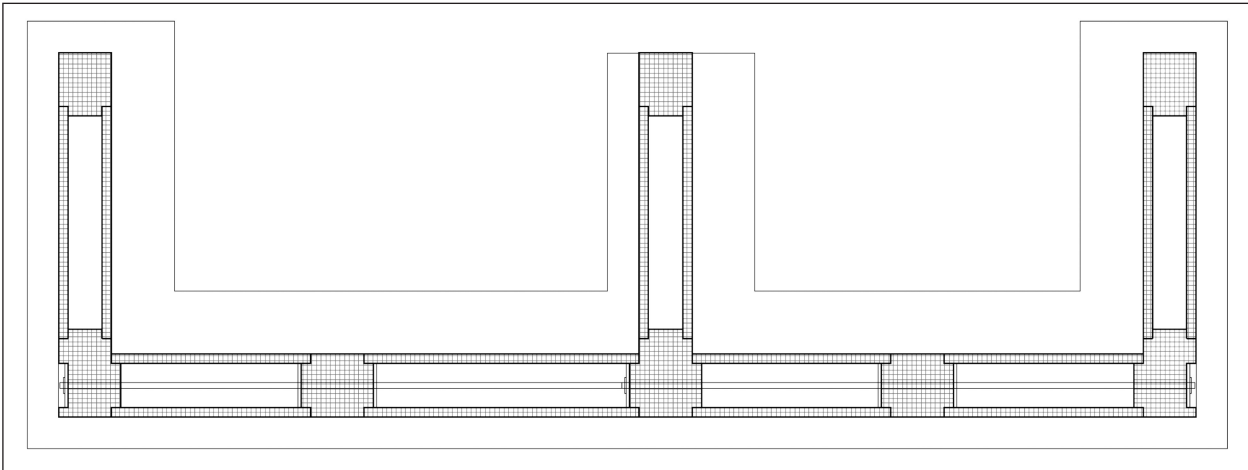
Grundriss Widerlager, Schalenbauweise
